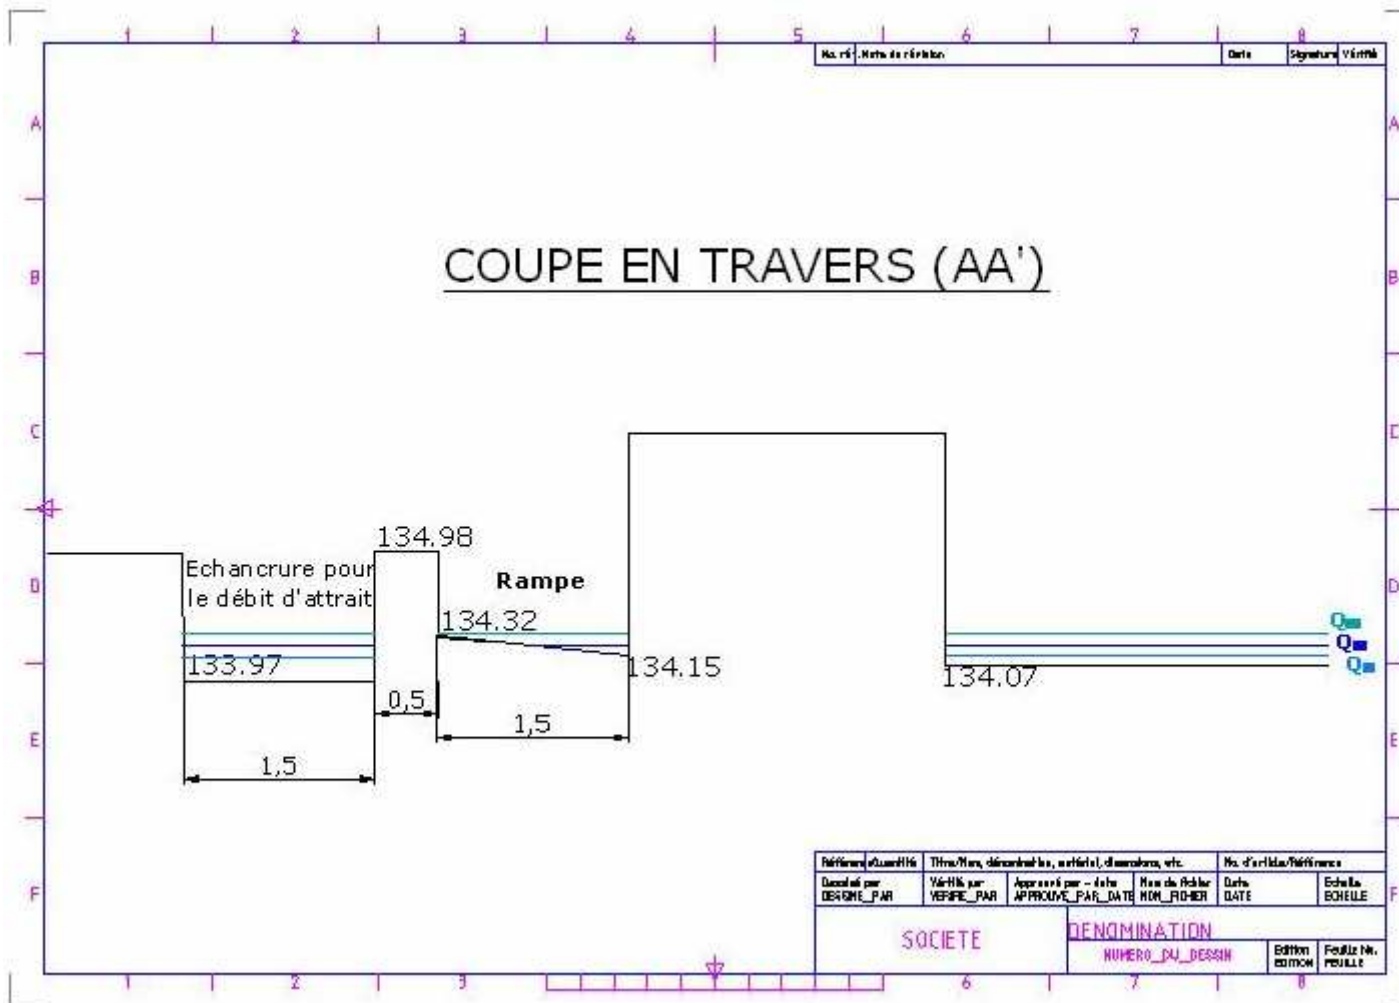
Coupe en travers au niveau de la crête du seuil avec le positionnement de la rampe et de l'échancrure du débit d'attrait
